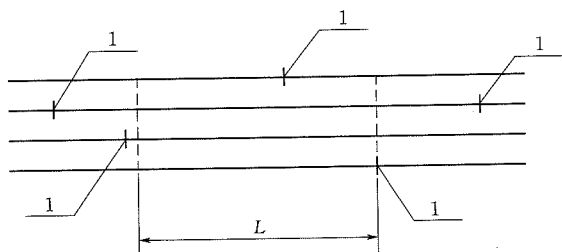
钢筋焊接和机械连接接头设置示意图
